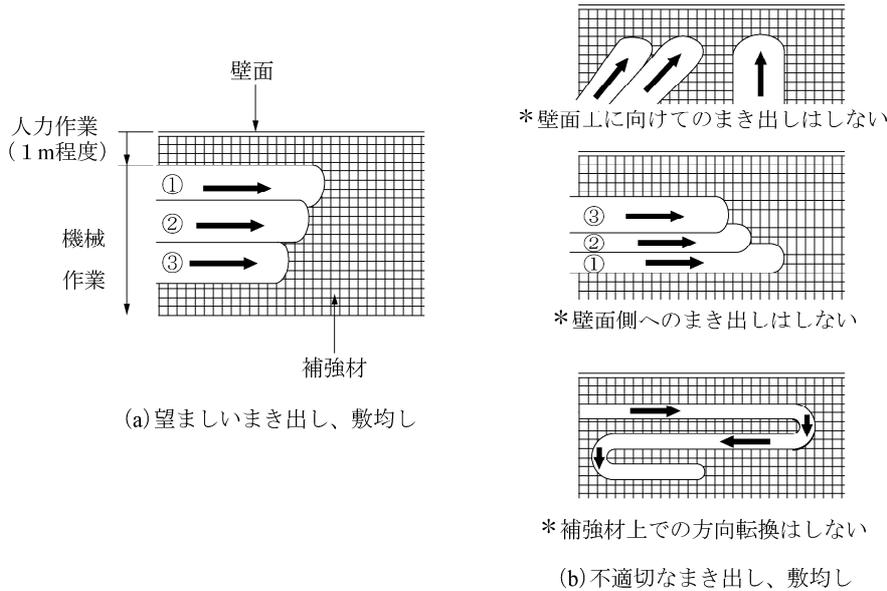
まき出し、敷均しの考え方⁸⁾
